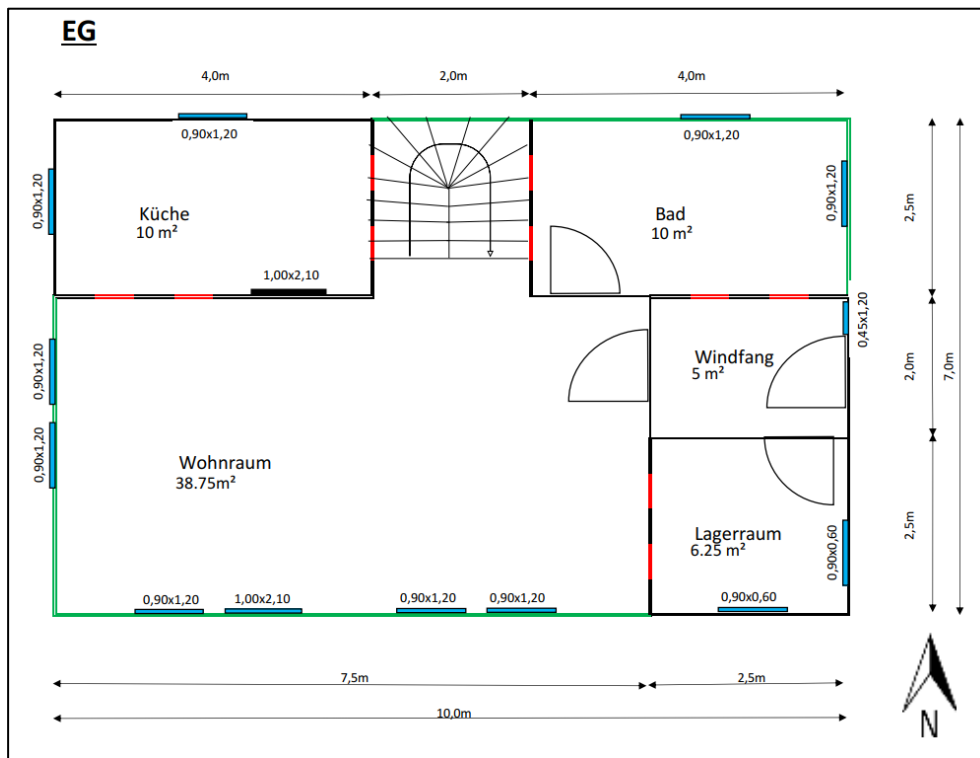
Grundriss Referenzgebäude, Erdgeschoss (Schett 2020)
